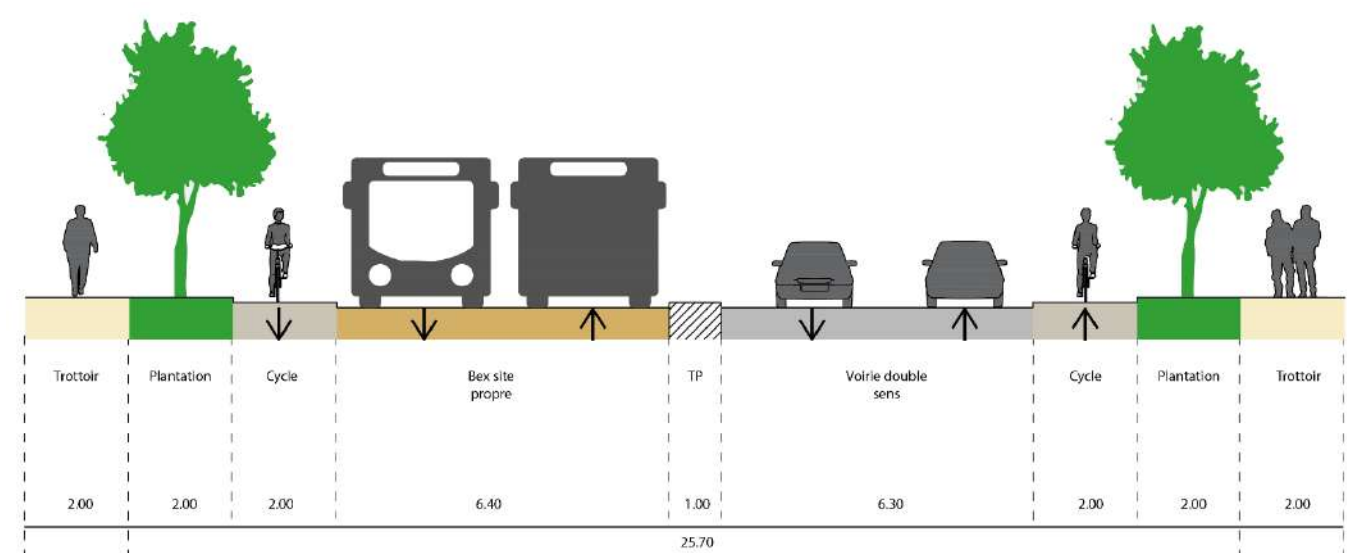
Coupe type pour l'insertion d'un site propre bidirectionnel latéral
